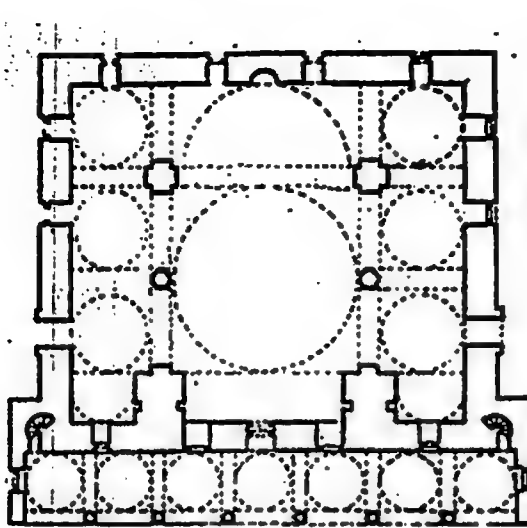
المسقط الأفقي لجامع محمود باشا في إستانبول .
